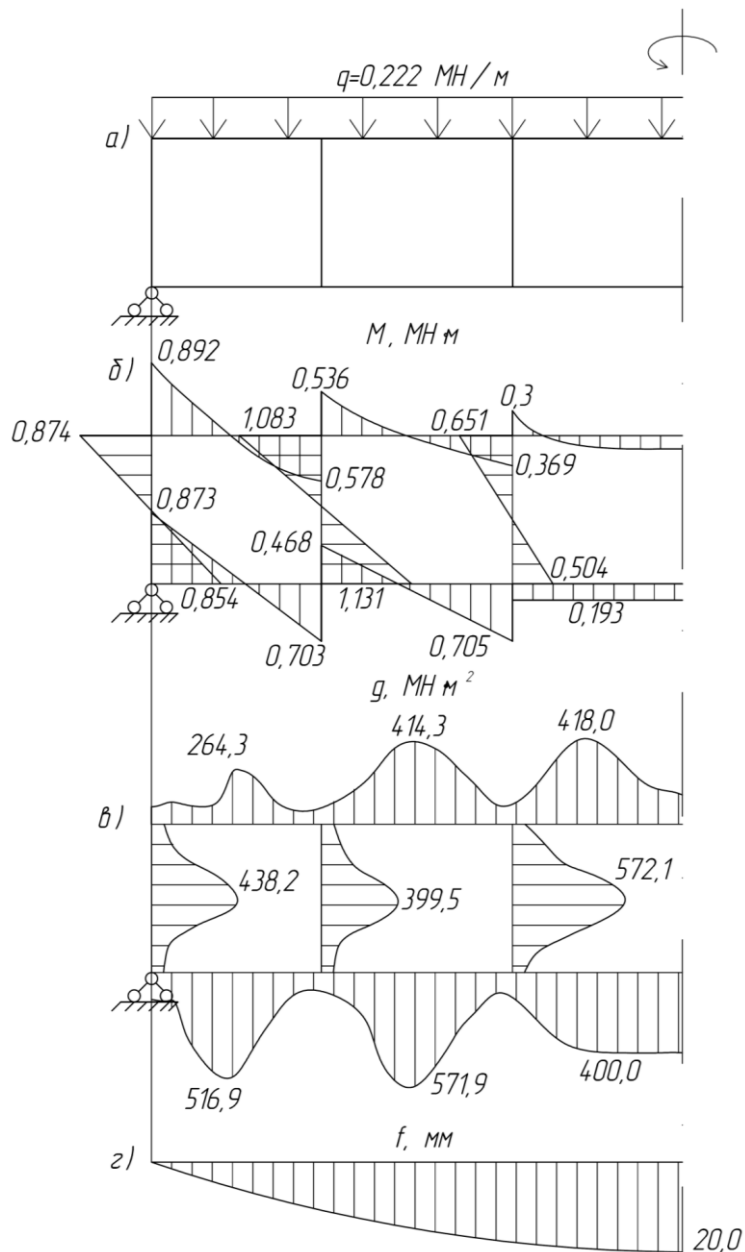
Деформирование подстропильной рамы: а – расчетная схема, б – эпюра изгибающих моментов, в – жесткость элементов, г – вертикальные перемещения
